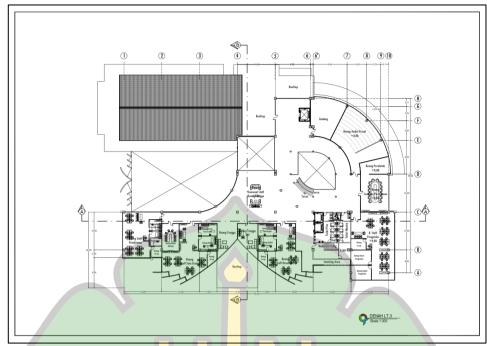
Layout Plan* Sumber: Data Pribadi
